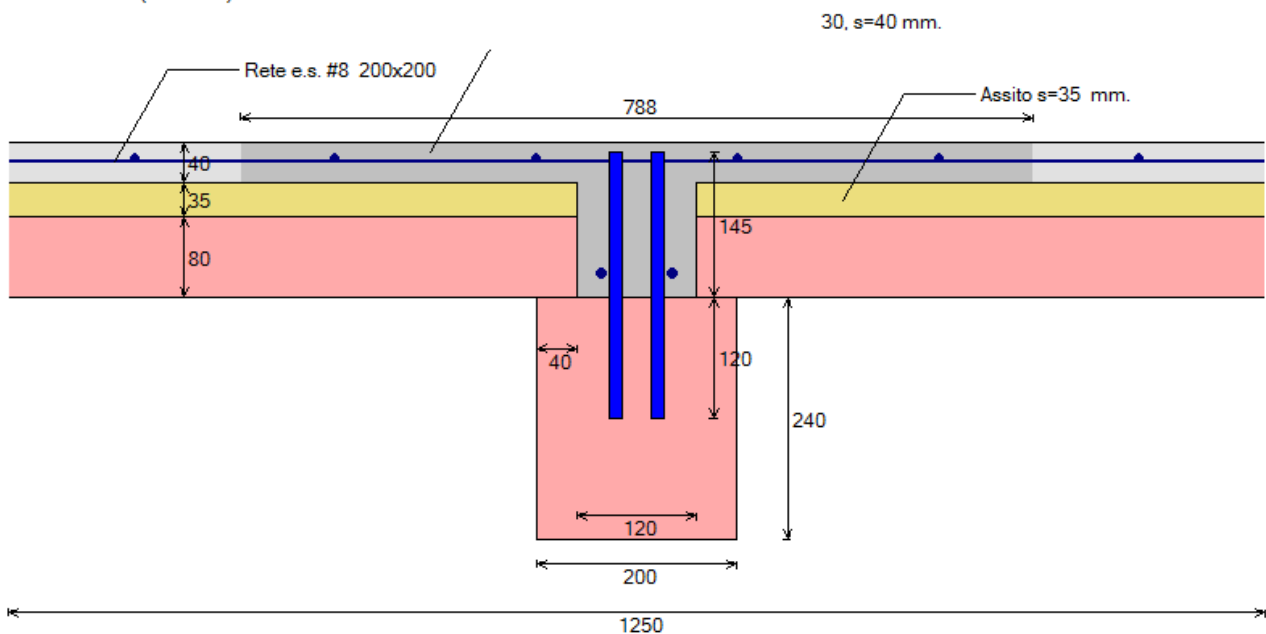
Grafica: Sezione A-A (sezione della trave principale)
